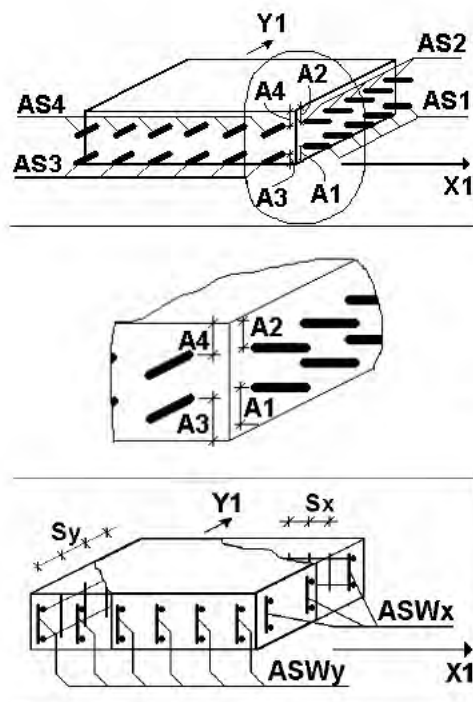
Армирование элементов железобетонной оболочки
